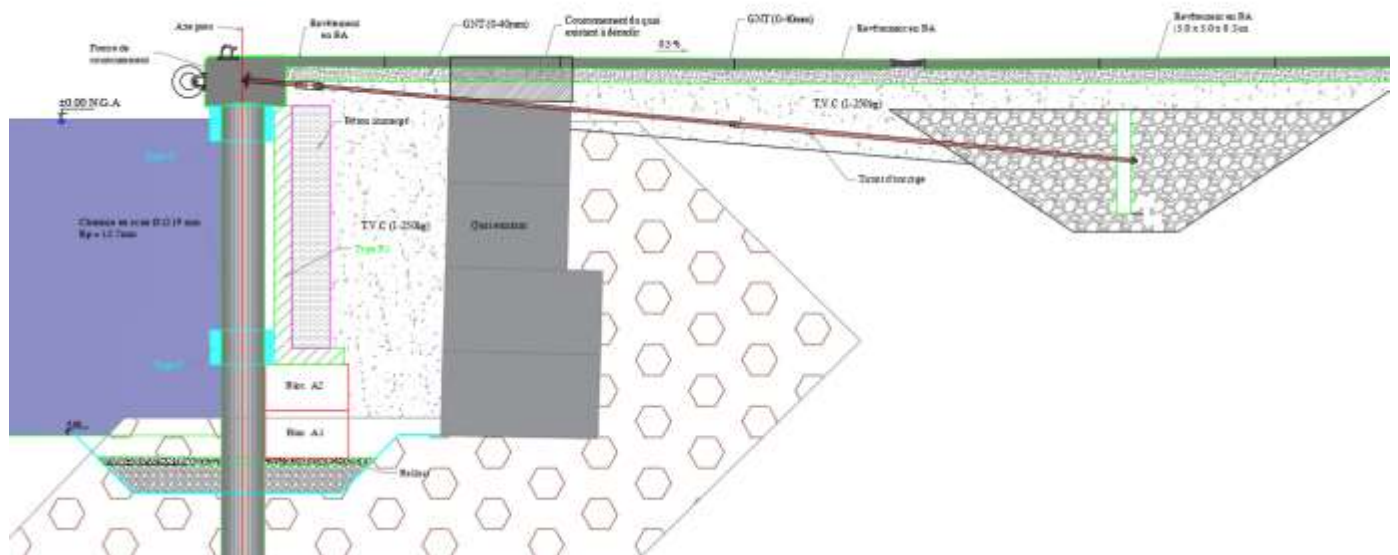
Coupe transversale du quai mixte (casbah)
